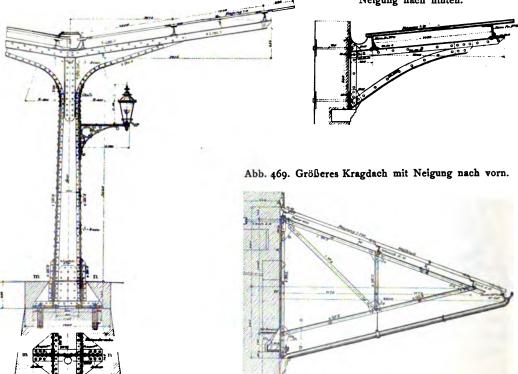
Kleines Kragdach mit Neigung nach hinten.
